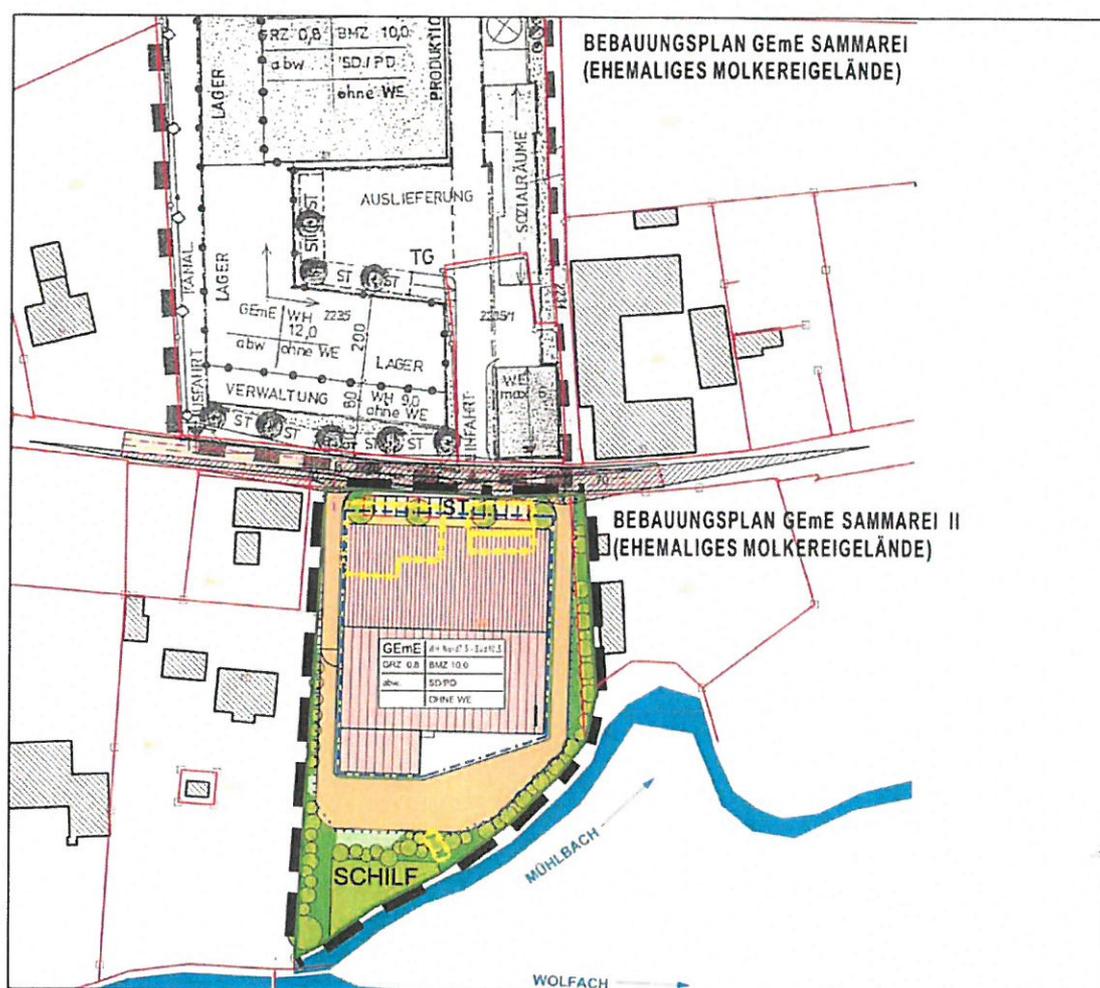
Planzeichnung zum Bebauungsplan "GE Sammarei II" des Marktes Ortenburg /65/
